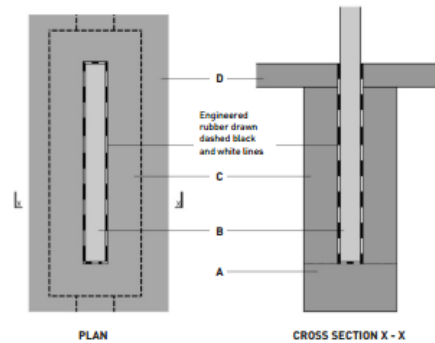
Fundação *socket* em planta e secção transversal (Chapman J., 2010).
